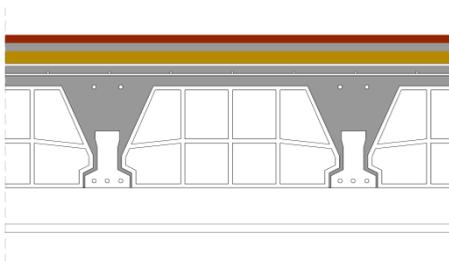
Forjado con suelo de gres. 2014. AutoCAD.
